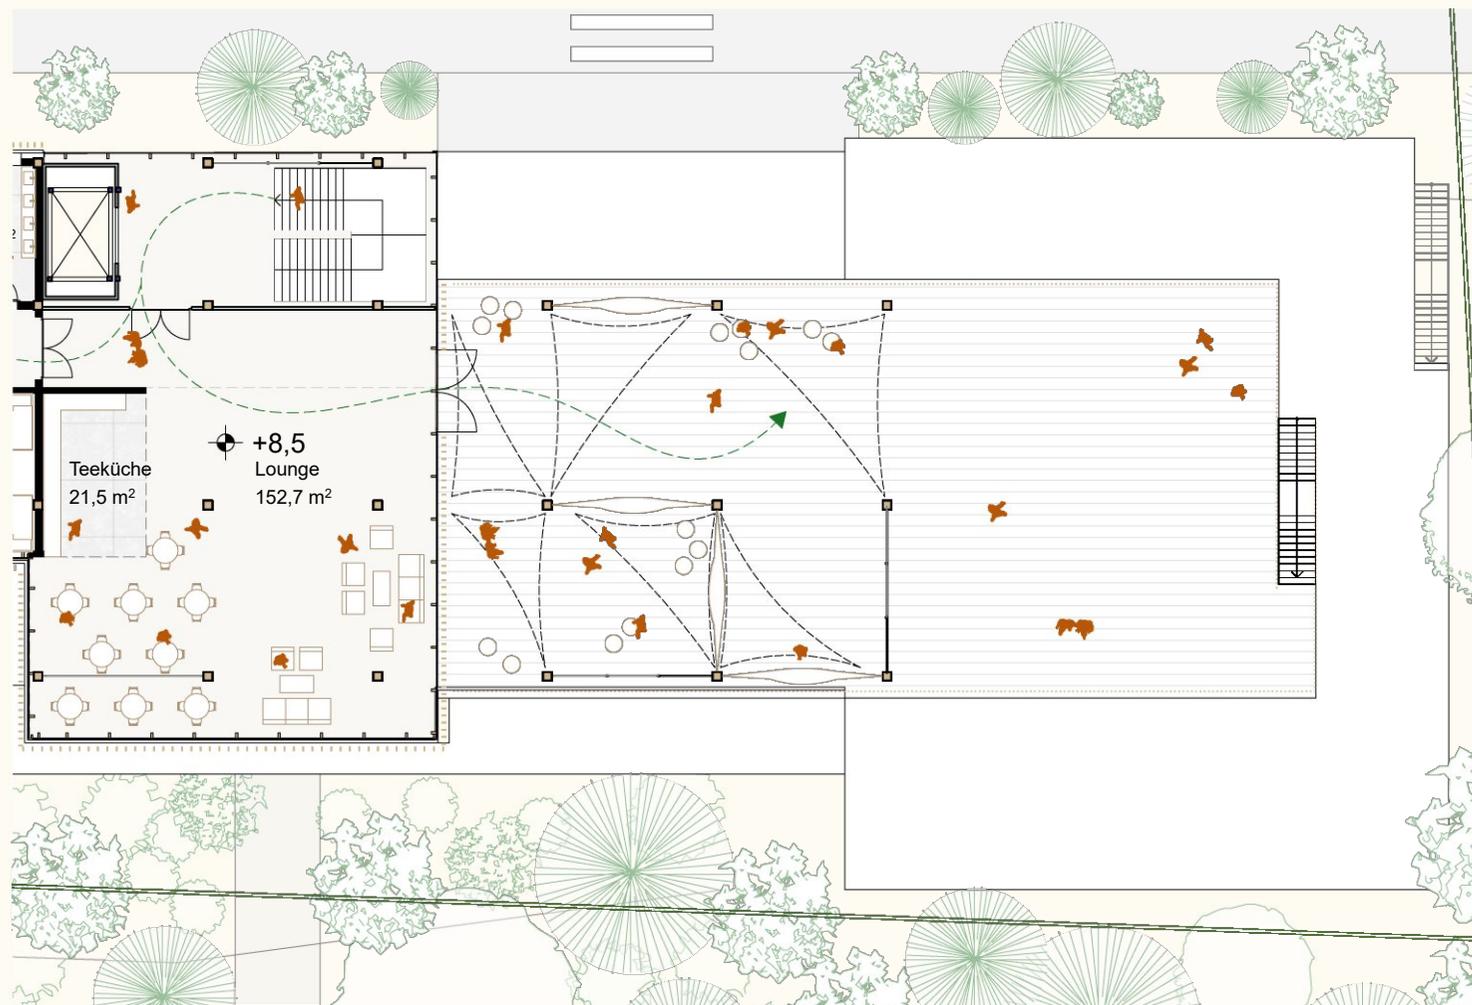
Grundriss Terrasse 2OG 1:200
